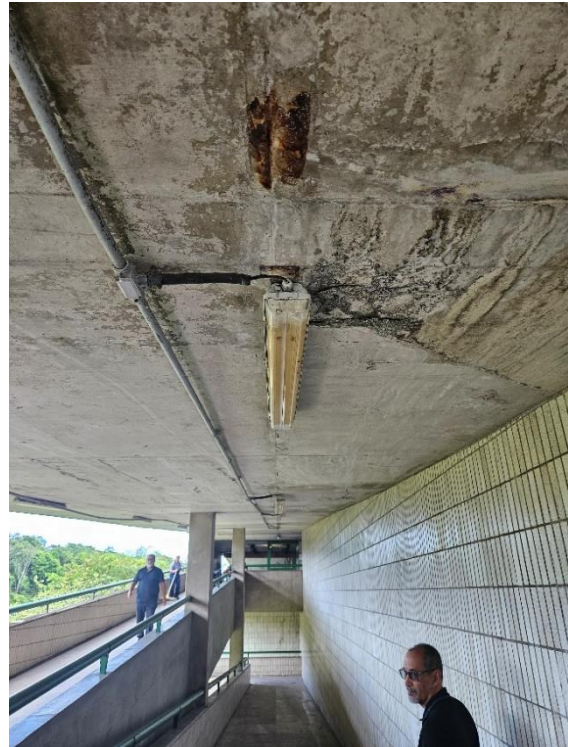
Infiltrações na Laje. Área de armazenamento de lixo pequena e com fechamento degradado. Rampa com desnível por lance maior que permitido por Norma, ferragens expostas, sem elementos de acessibilidade
